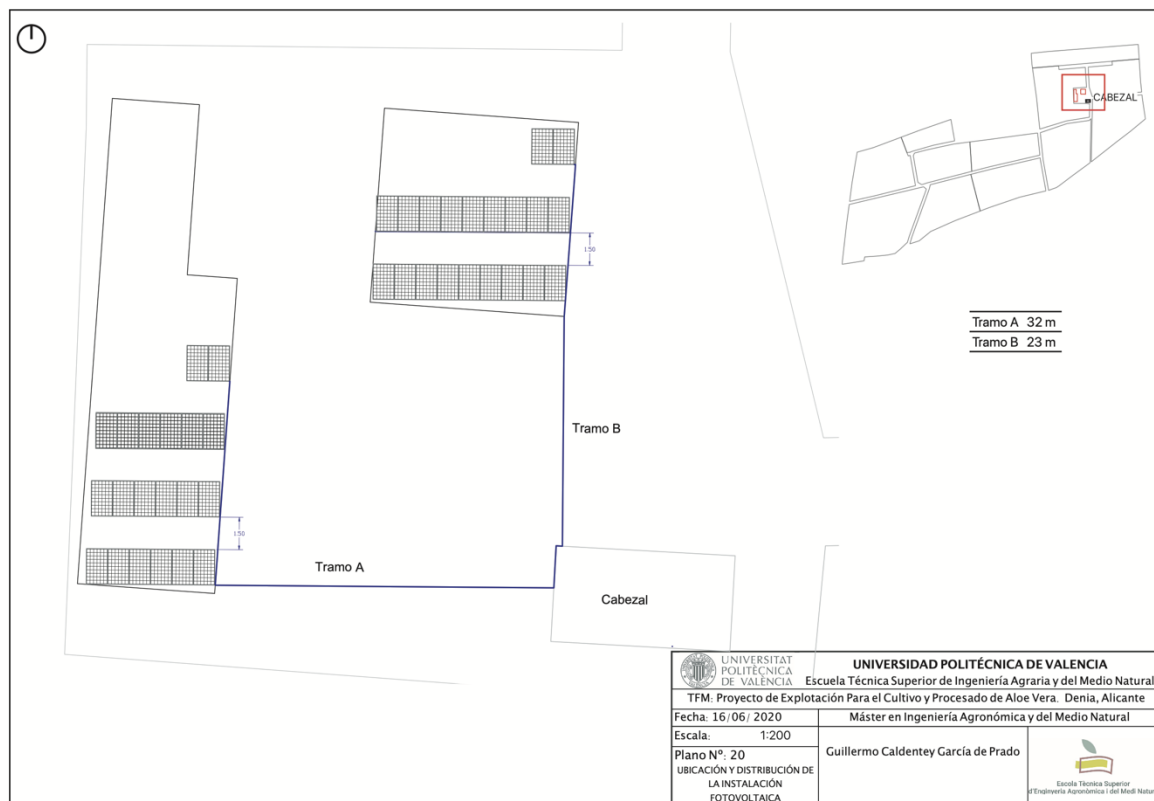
Longitudes tramos A y B. Detalle Plano 20. Ubicación y Distribución de la Instalación Fotovoltaica
